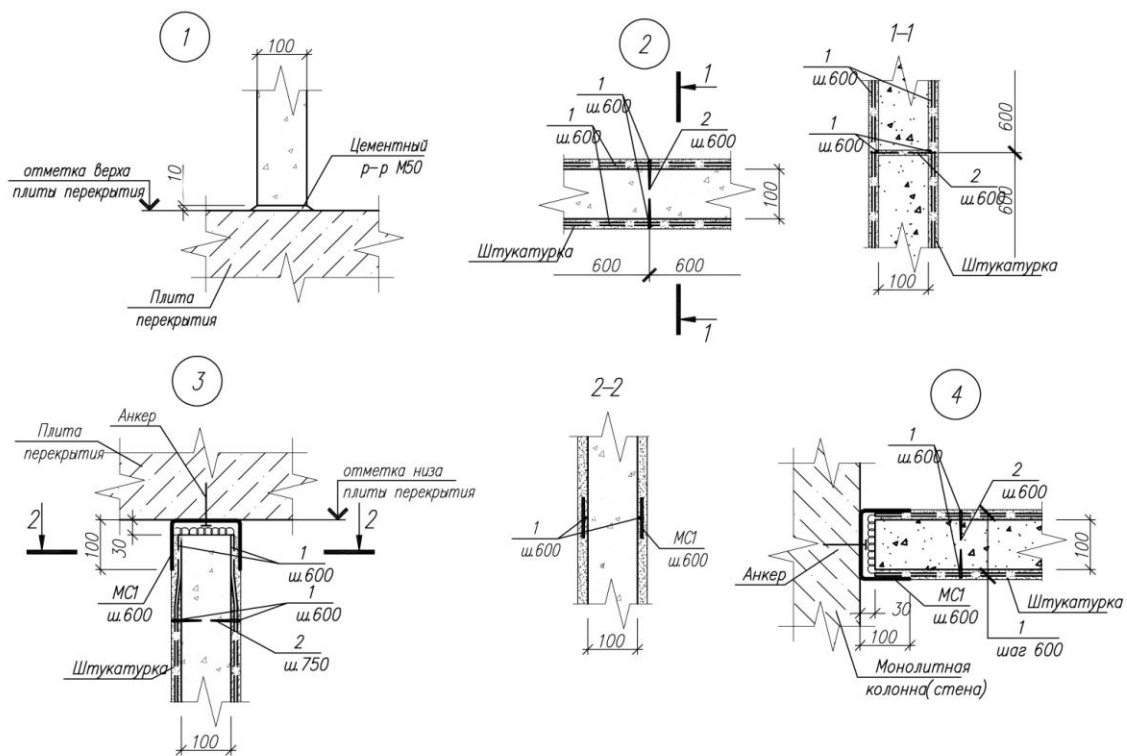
Узлы перегородок из керамзитобетонного блока толщиной 100мм
